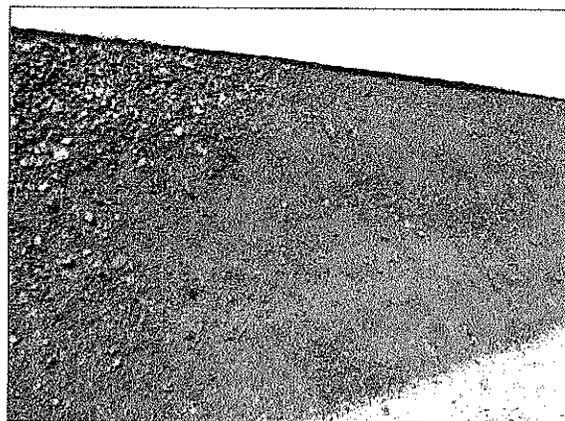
Pavimento manchado con asfalto en su superficie en Ruta T-205.
